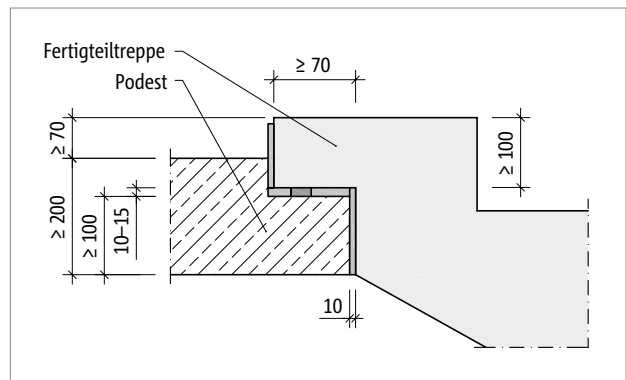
Schöck Tronsole® Typ BZ: Ausführungsvariante Auflagerung eines Elementtreppenlaufs am Podestrand mit Konsolausbildung
